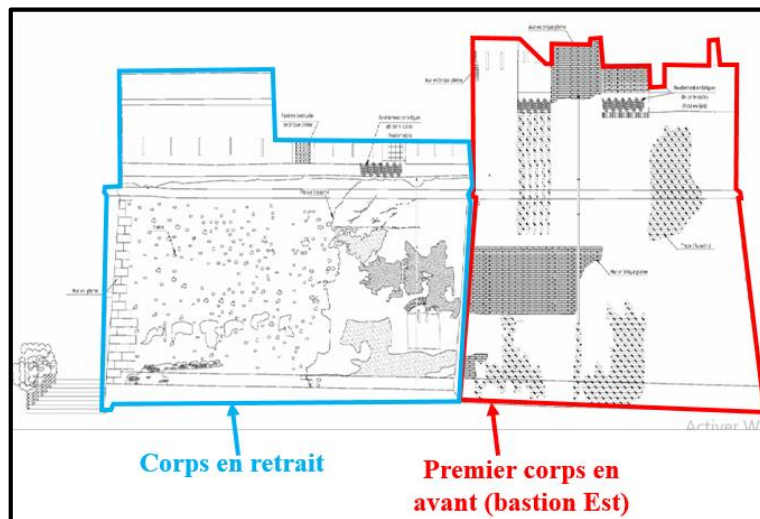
Façade Est de Bordj Moussa (Source : BET MAHINDAD, traitée par l'auteur 2025).
